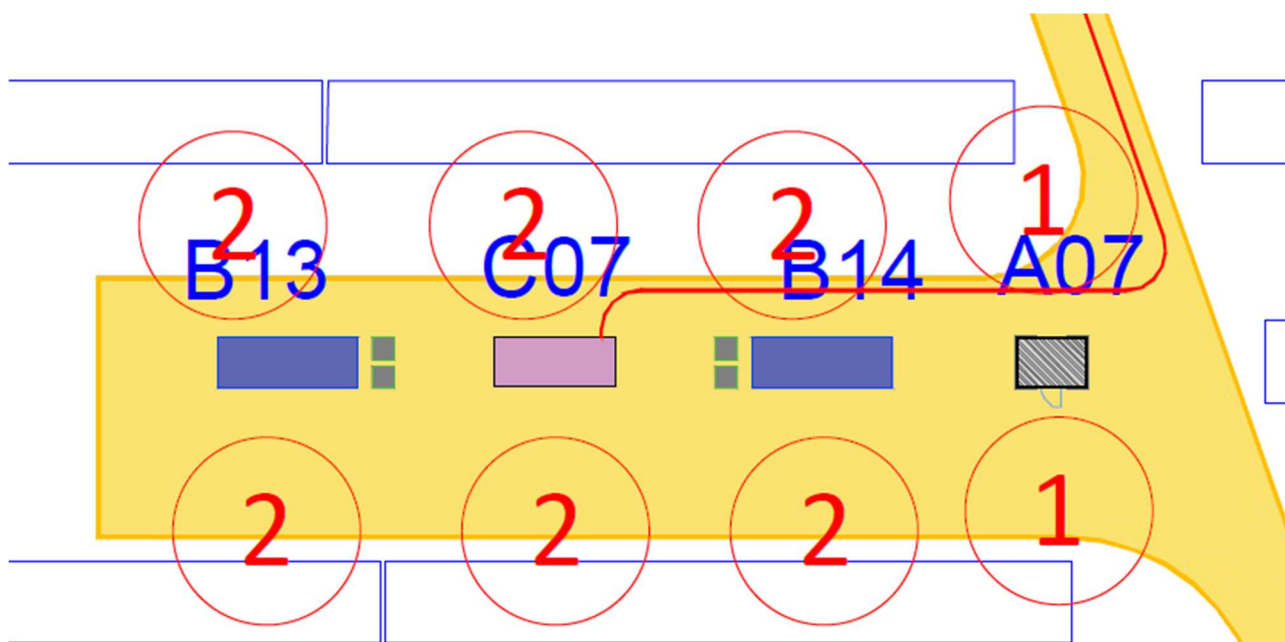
Layout impianto di illuminazione - Dettaglio piazzale sottocampo
